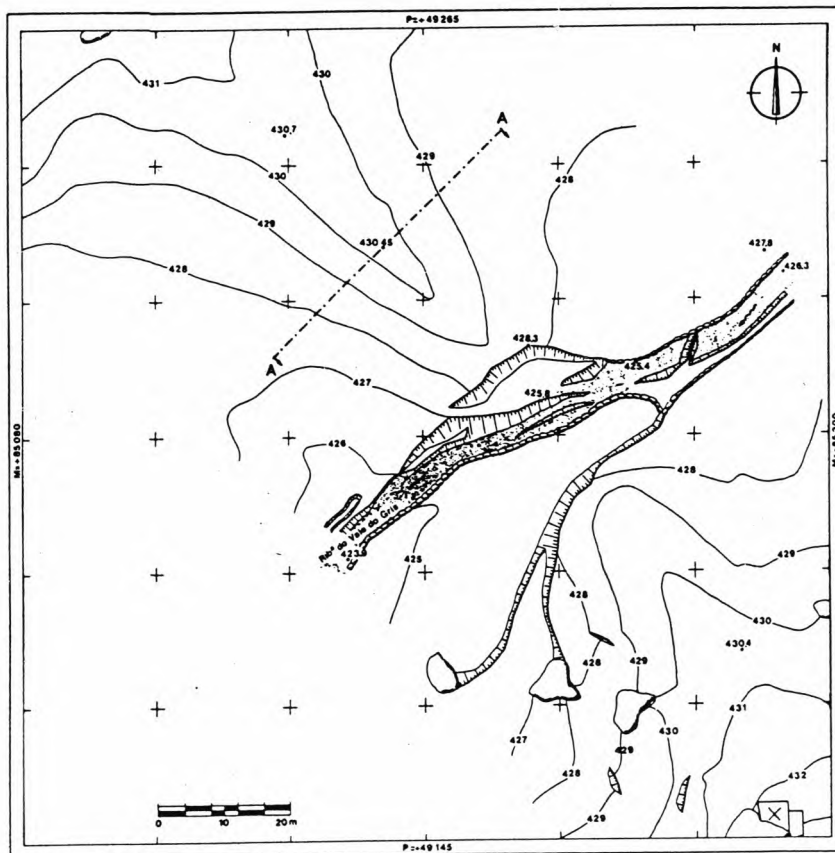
Barragem da Lajinha (Penamacor). Planta da barragem
